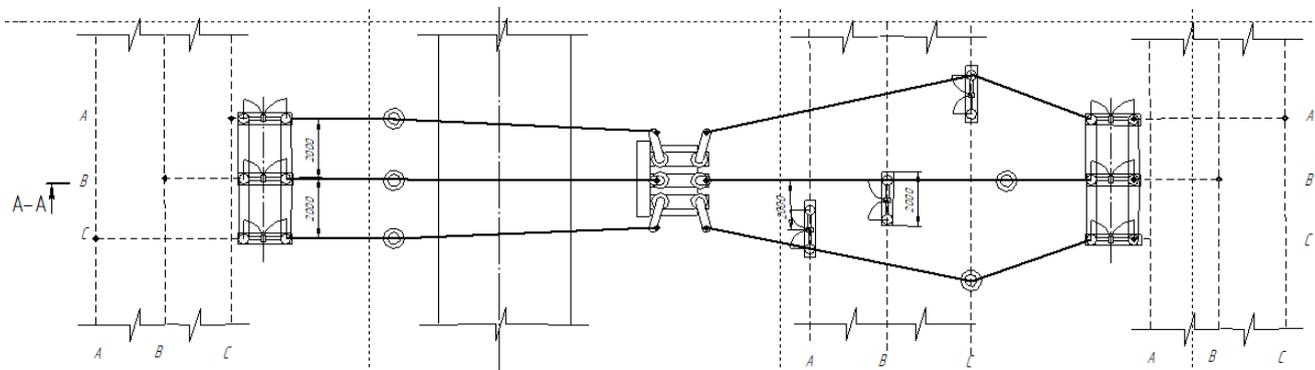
Типовая компоновка схемы с двумя рабочими и обходной системами шин на напряжении 110 кВ (вид сбоку и вид сверху)
